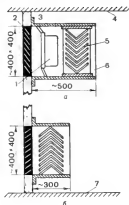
Устройство вентиляционных отверстий в фотолаборатории (а — вытяжное отверстие; б — приточное): 1 — вентилятор; 2 — фанерные ребра; 3 — резиновые растяжки; 4 — потолок; 5 — прессшпанный светозащитный «лабиринт»; 6 — съемная рамка; 7 — пол
